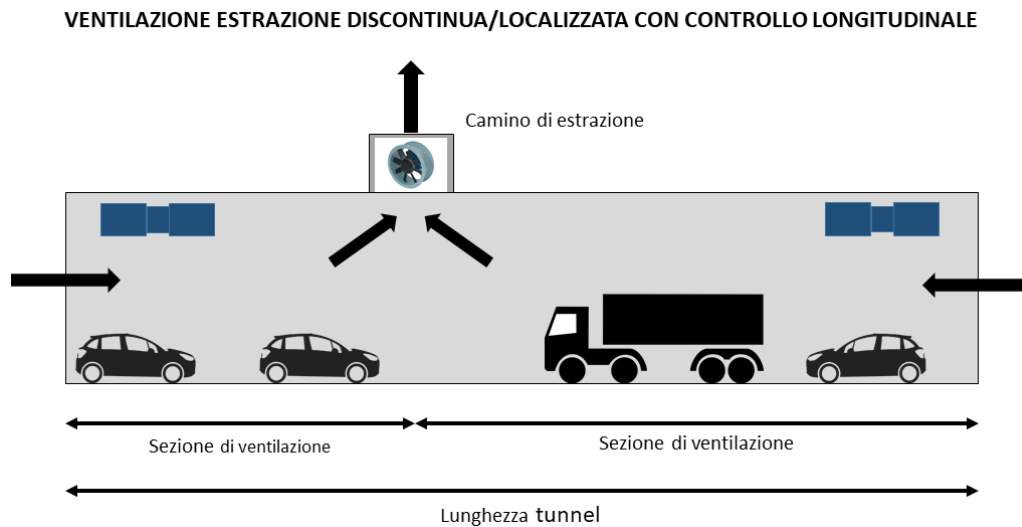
Schema di funzionamento della ventilazione longitudinale con camino di estrazione.
